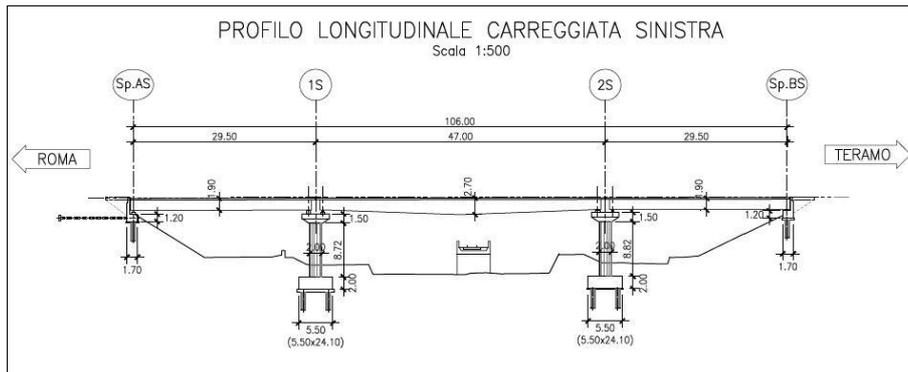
Prospetto viadotto Aterno – Stato attuale
